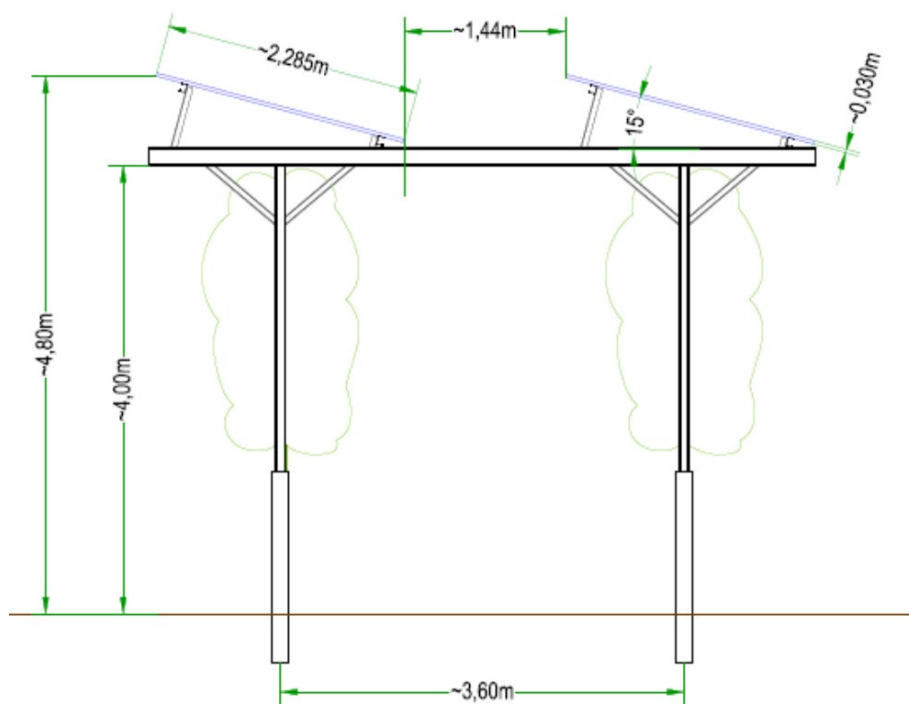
plan de coupe des installations projetées (source : BayWa r.e.)
